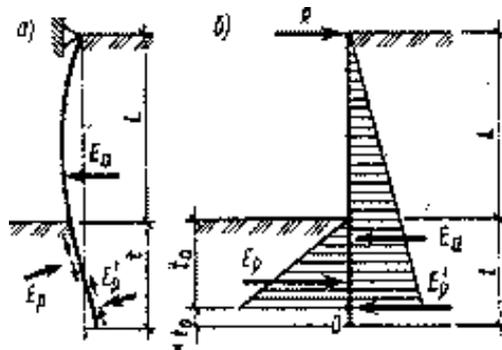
Расчет стены с одним ярусом креплений по схеме Блюма-Ломейера:
